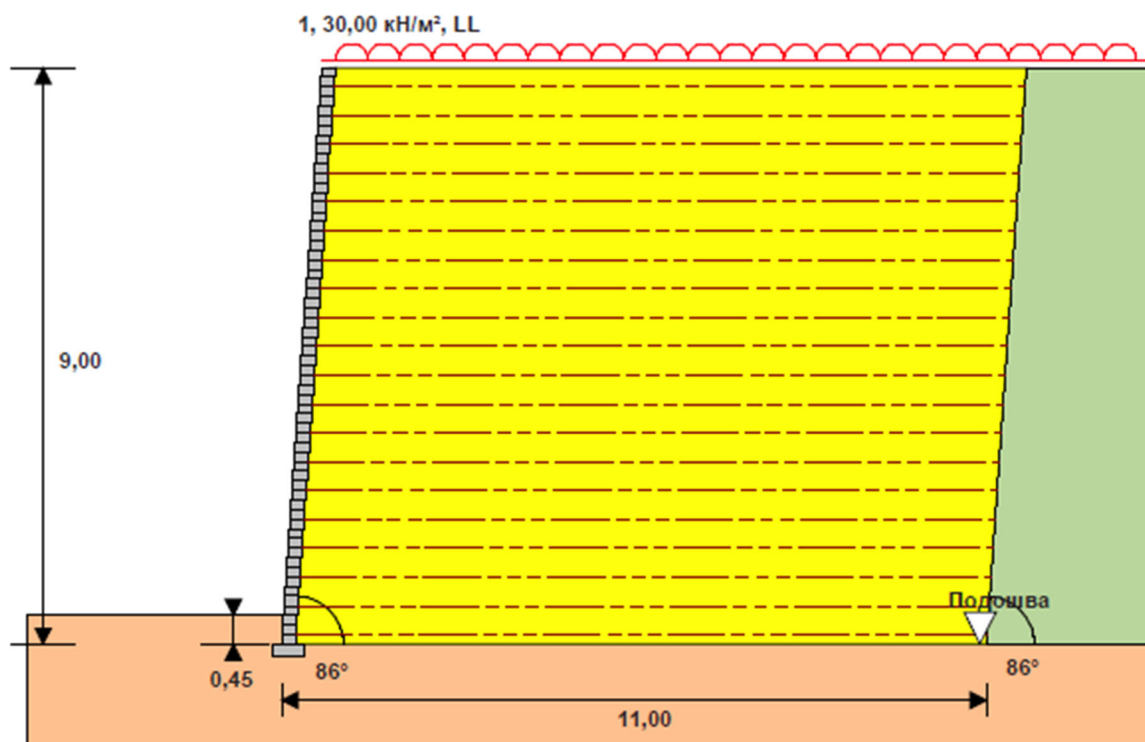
Розрахункова схема блоку армоґрунтової конструкції (метод Бішопа, статичний аналіз, TENSAR WALL).
